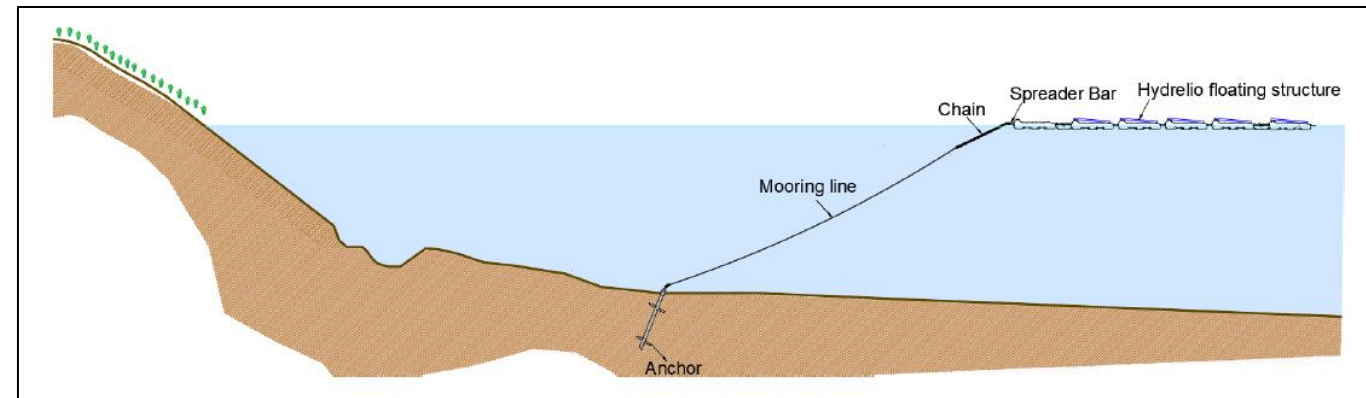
Exemple d'ancrage au fond (Source : Ciel et Terre)
